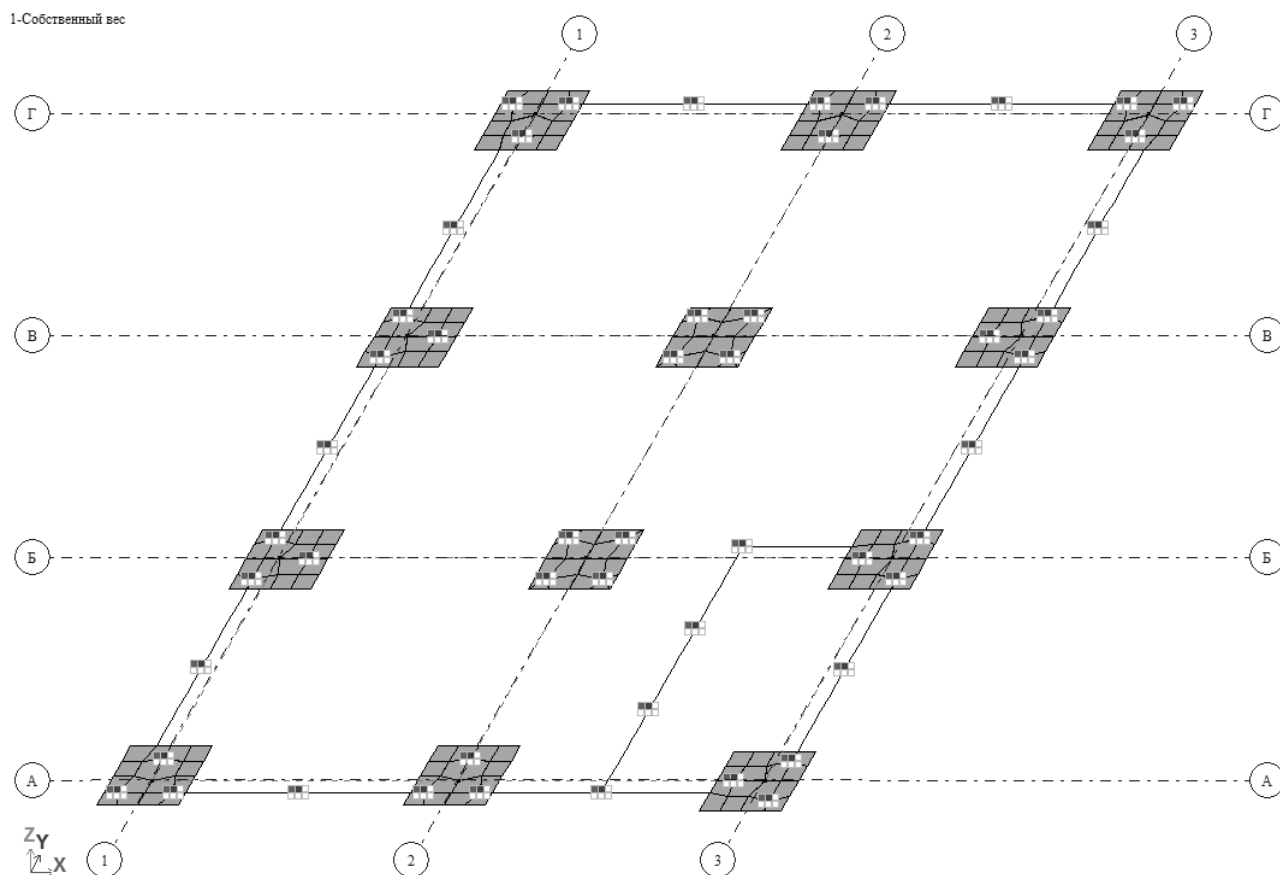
Схема закрепления опорных узлов расчетной схемы
